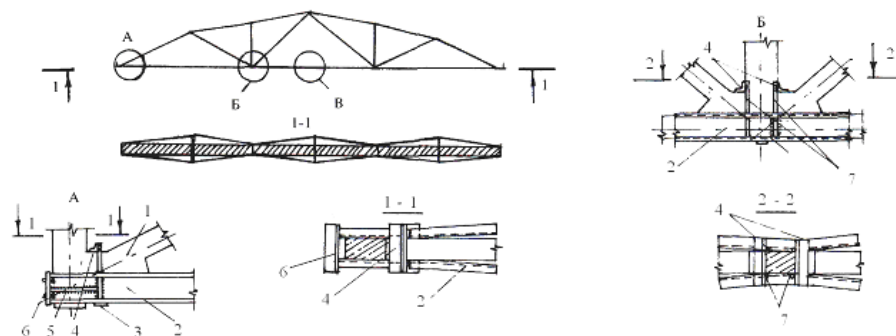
Усиление нижнего пояса железобетонной фермы жесткой затяжкой из швеллеров:
